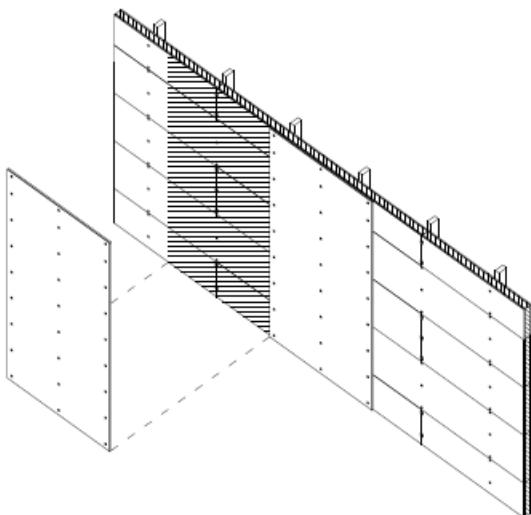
Instalación de placas de yeso laminado sobre paneles WALL.
